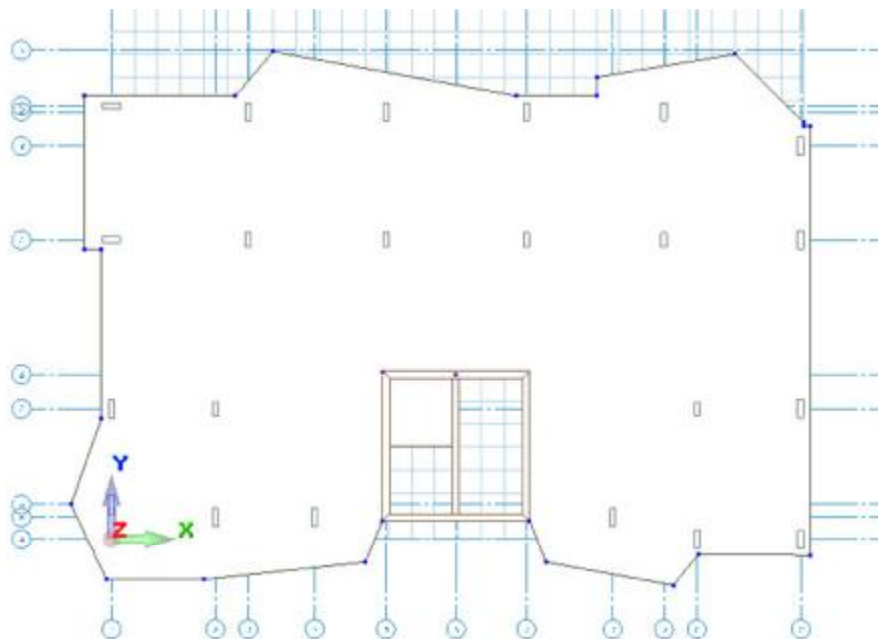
Расположение проема в плите перекрытия на виде сверху
